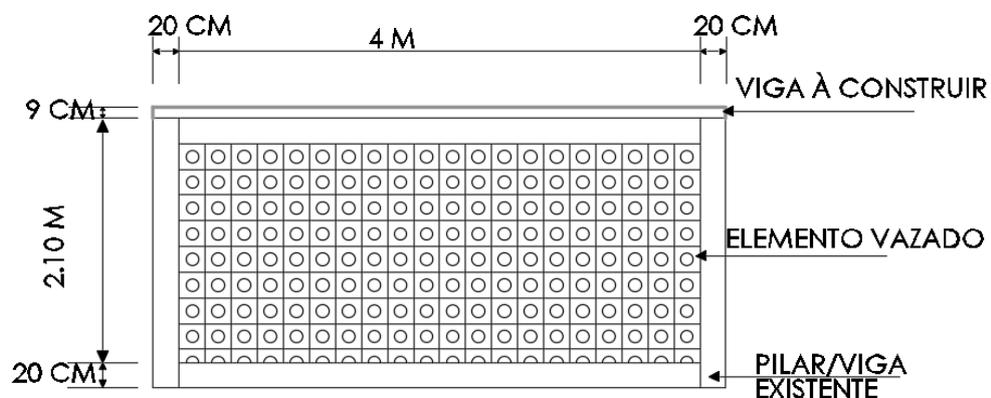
Detalhamento do elemento vazado com os pilares e as vigas.
